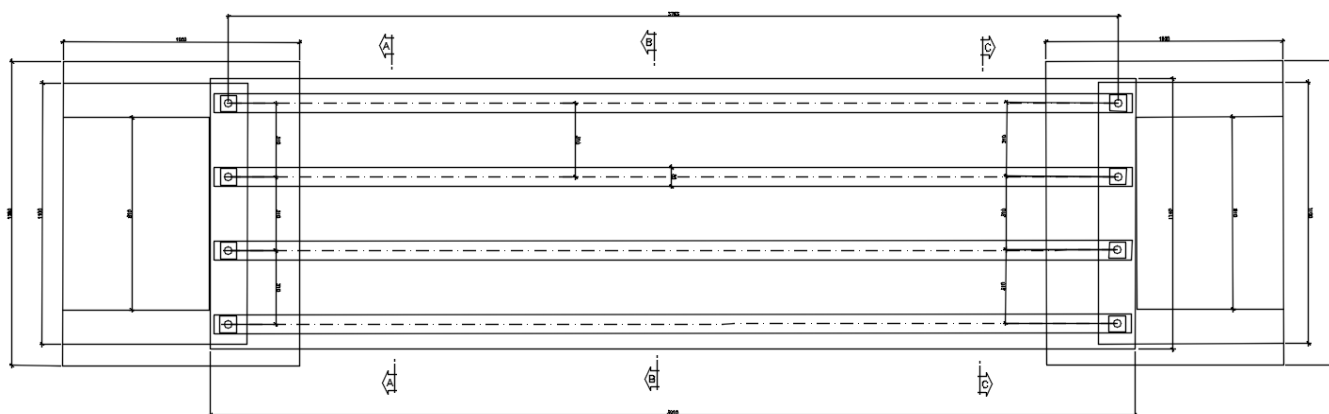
IV01 – Prospetto in retto impalcato Spalla A
